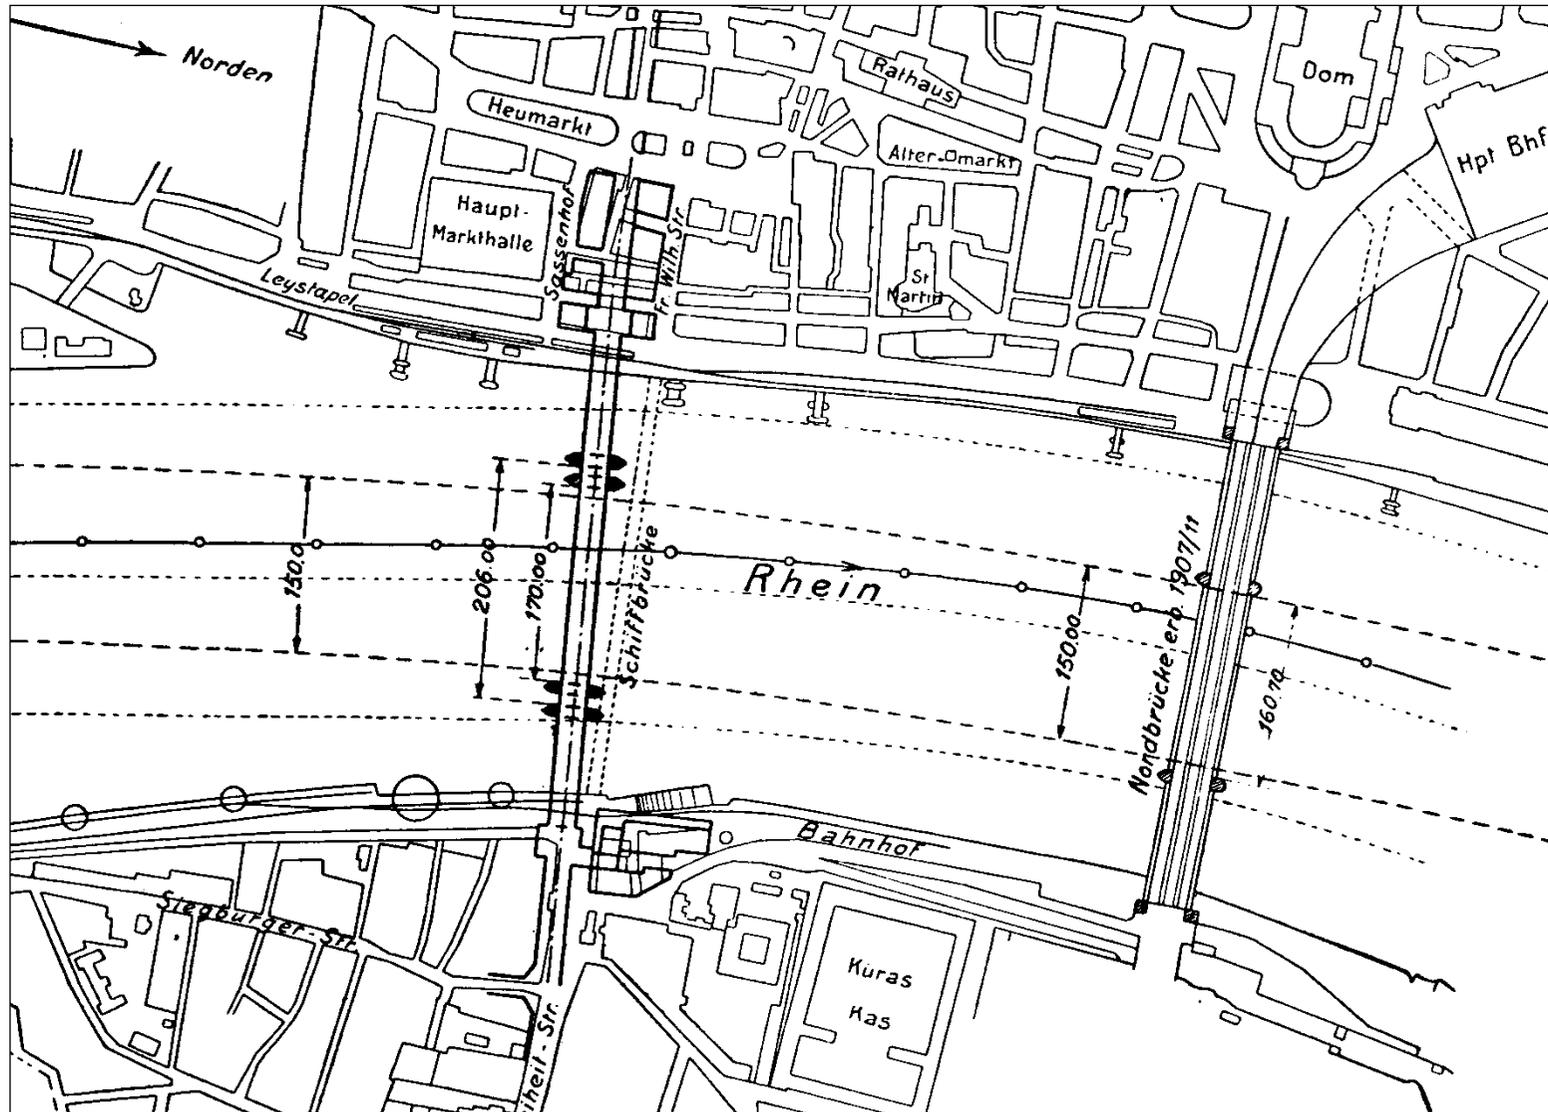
Allgemeiner Lageplan des 1910/11 öffentlich und 1912/13 beschränkt durchgeführten Wettbewerbs für die städtische Straßenbrücke (Ersatz Schiffbrücke). Der Plan enthält Angaben über die geplante Bebauung in der Umgebung der Brückenrampen am altstädtischen Ufer (oben) und auf der Deutzer Seite (unten). Rechts die Trasse der von 1907 bis 1911 anstelle der ehemaligen Dombrücke errichteten Hohenzollernbrücke.
